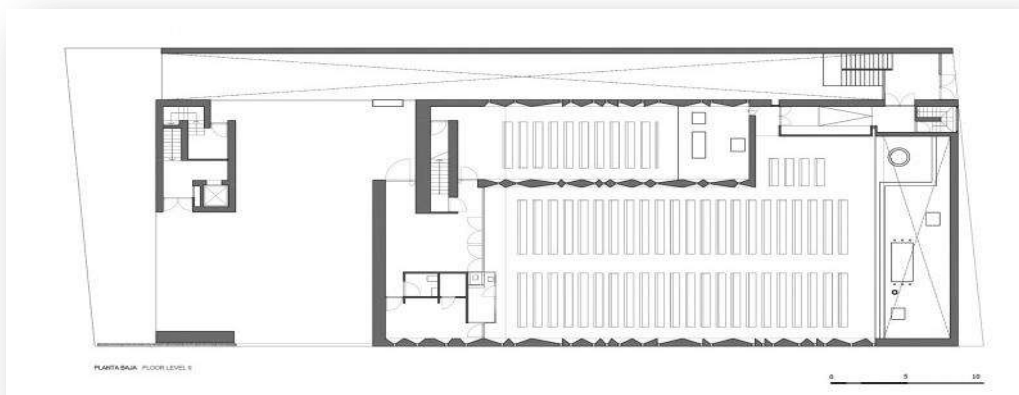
Planta baja arquitectónica de la iglesia de la parroquia de Córdoba.
